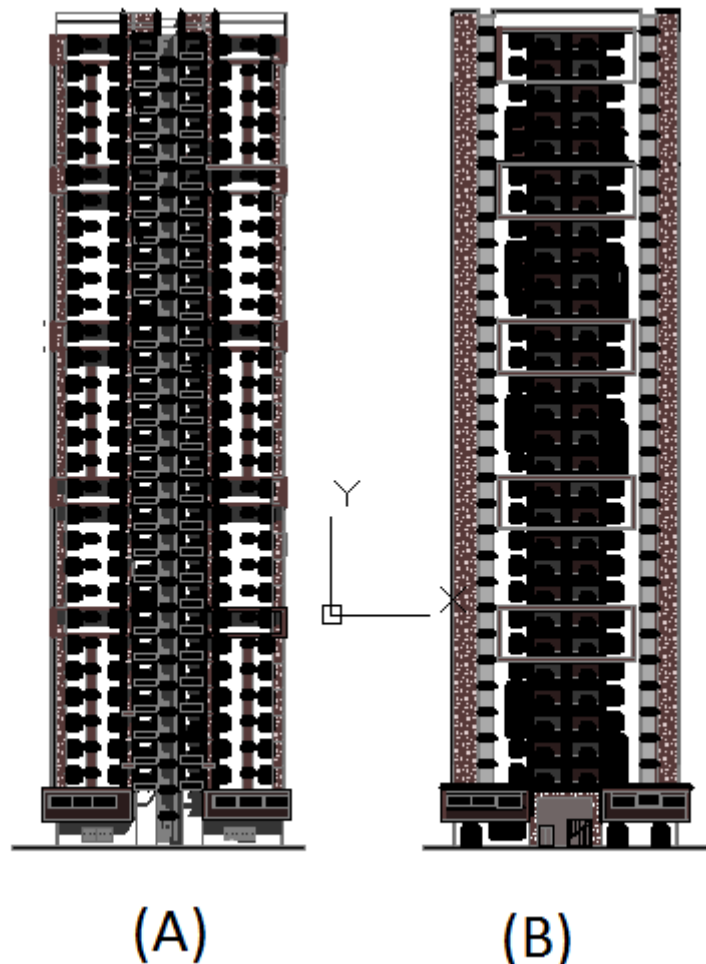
(A) Plan façade principale, (B) plan façade latérale.
